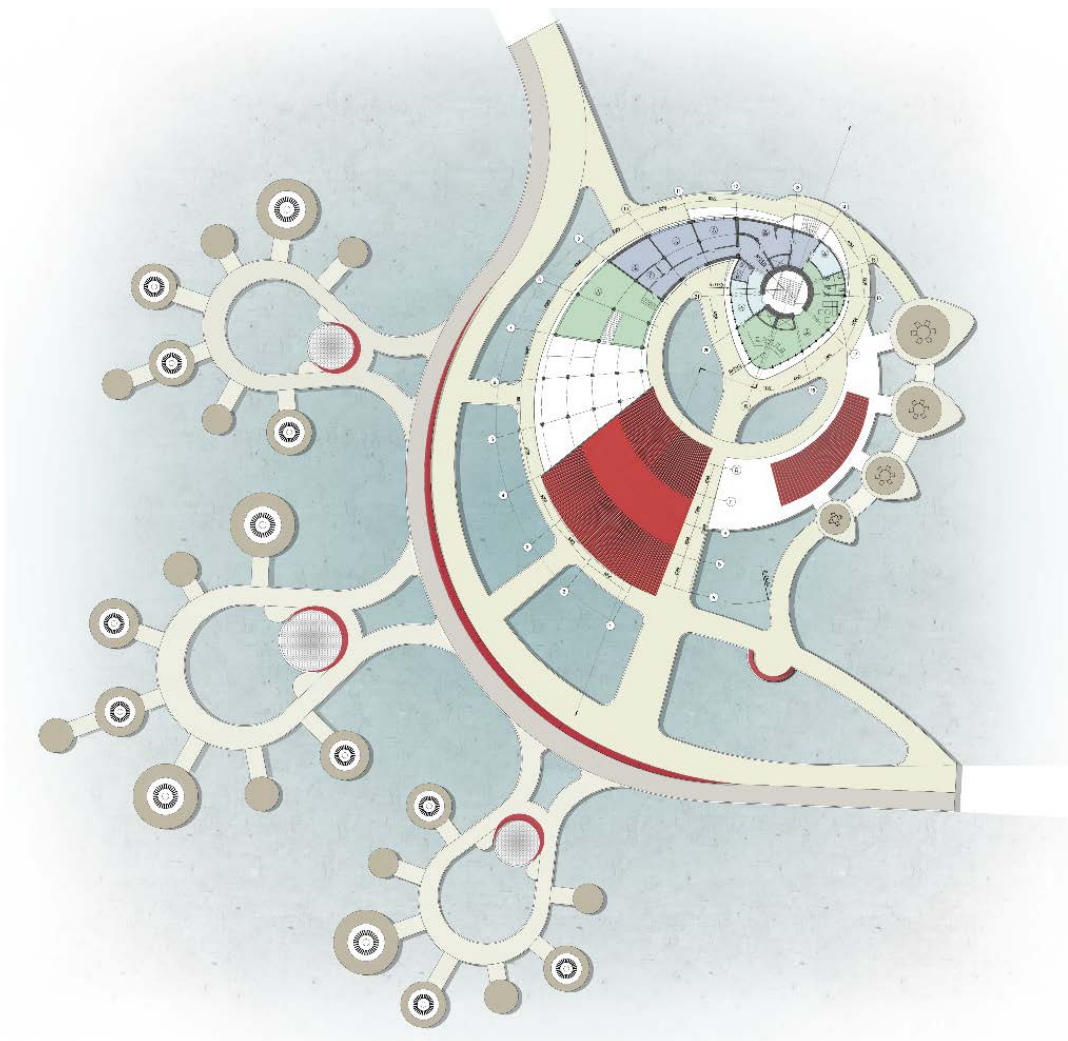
План 2-ого этажа (на отметке +4.000)
